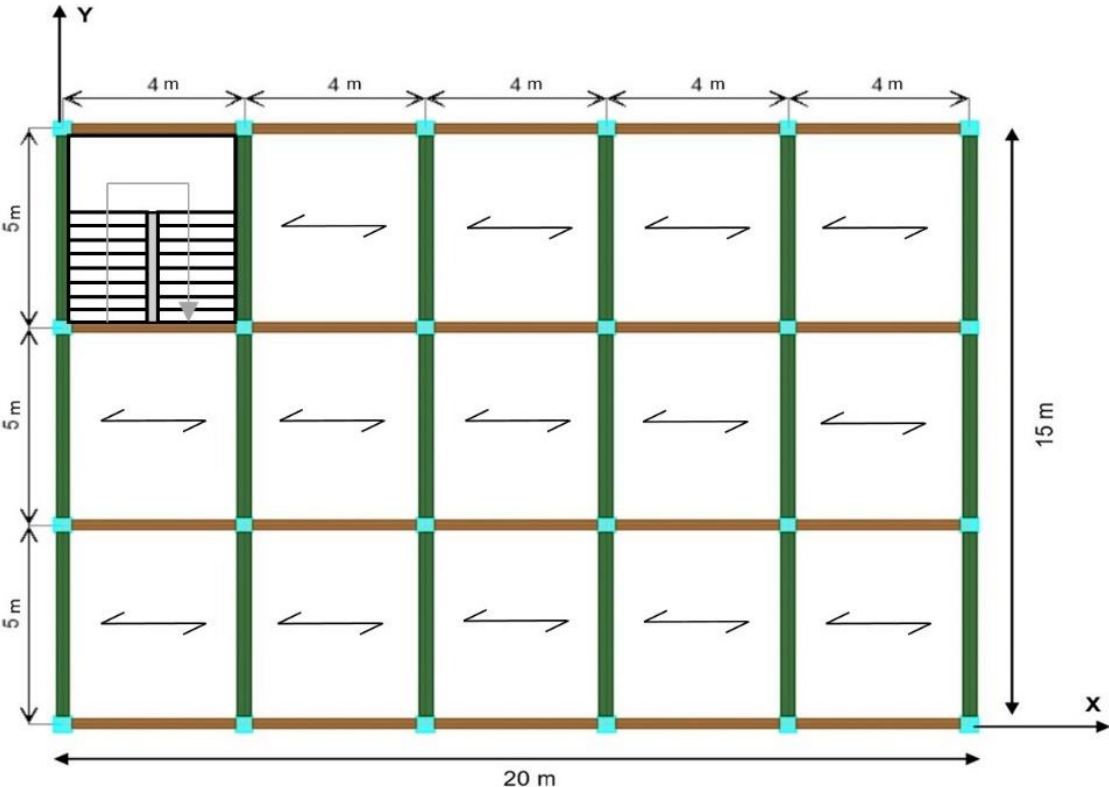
Vue en plan de la structure de type D : escalier positionné à la première travée suivant la direction X-X et à la troisième travée suivant la direction Y-Y.
